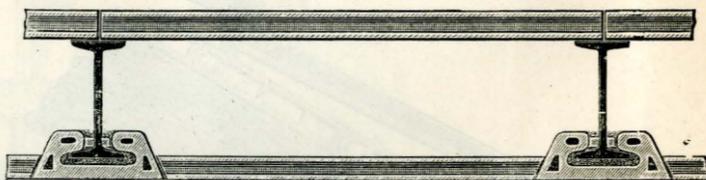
Sezione longitudinale (struttura con ferri I).
